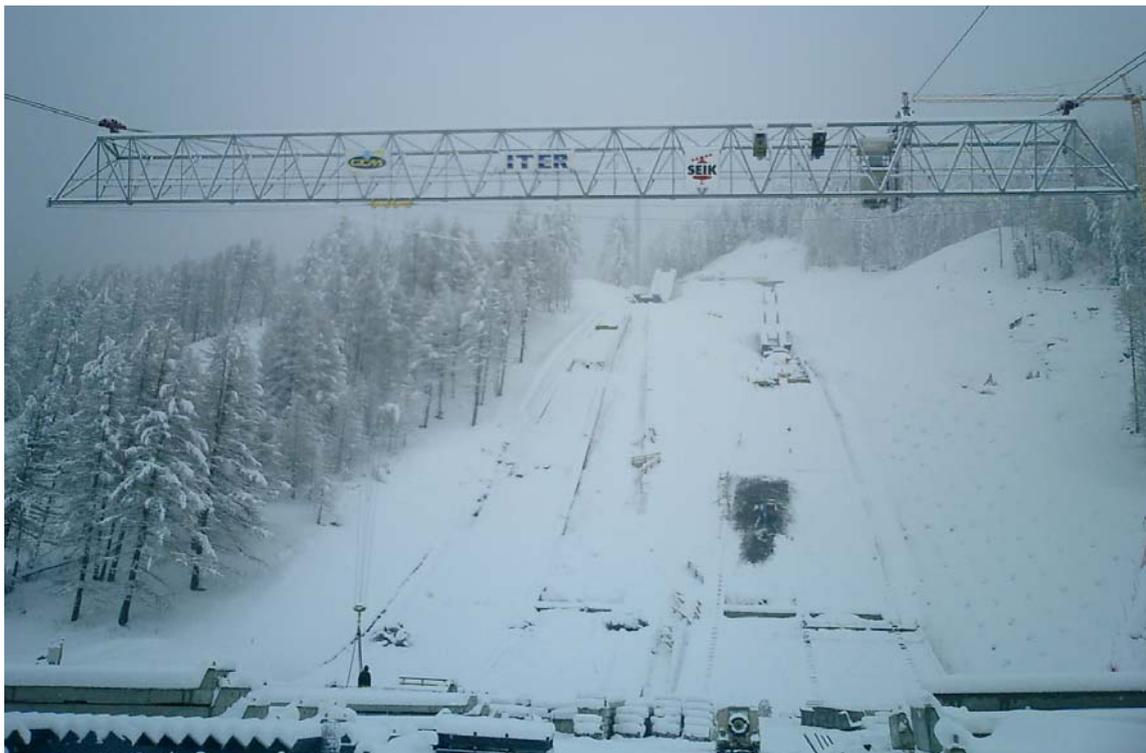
Impianto speciale a carro ponte su funi "Cantiere Trampolini" – Pragelato (TO).
